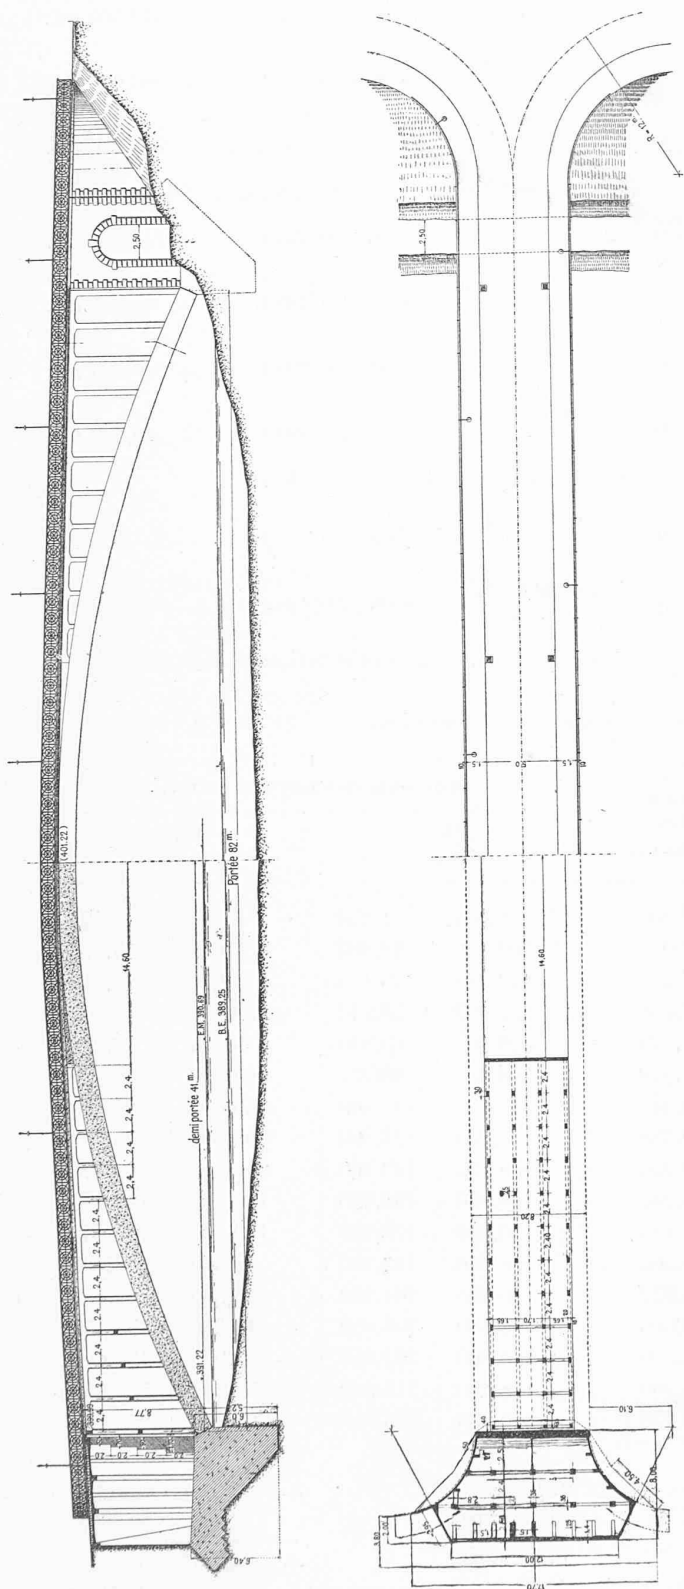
Elevation, plan et coupes. — Echelle 1 : 500.
